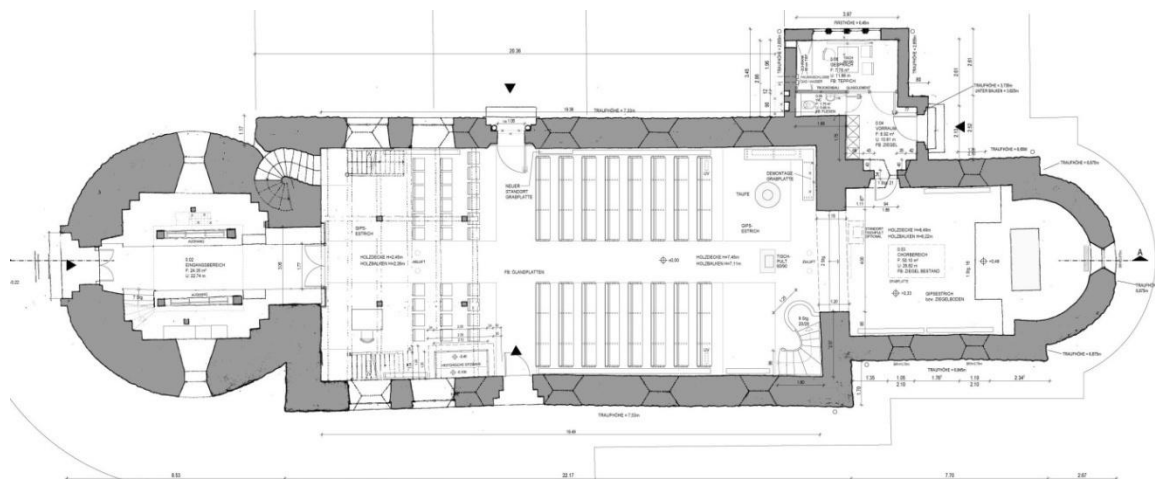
Grundriss Sanierungsplanung Kirche Ratekau (Architektur + Stadtplanung)
